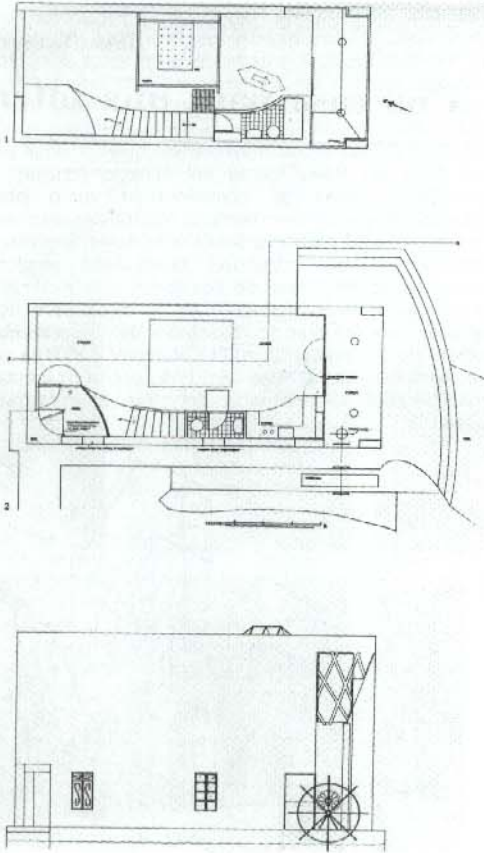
Plantas y alzado. Casa para una intersección. Juan Navarro Baldeweg.
